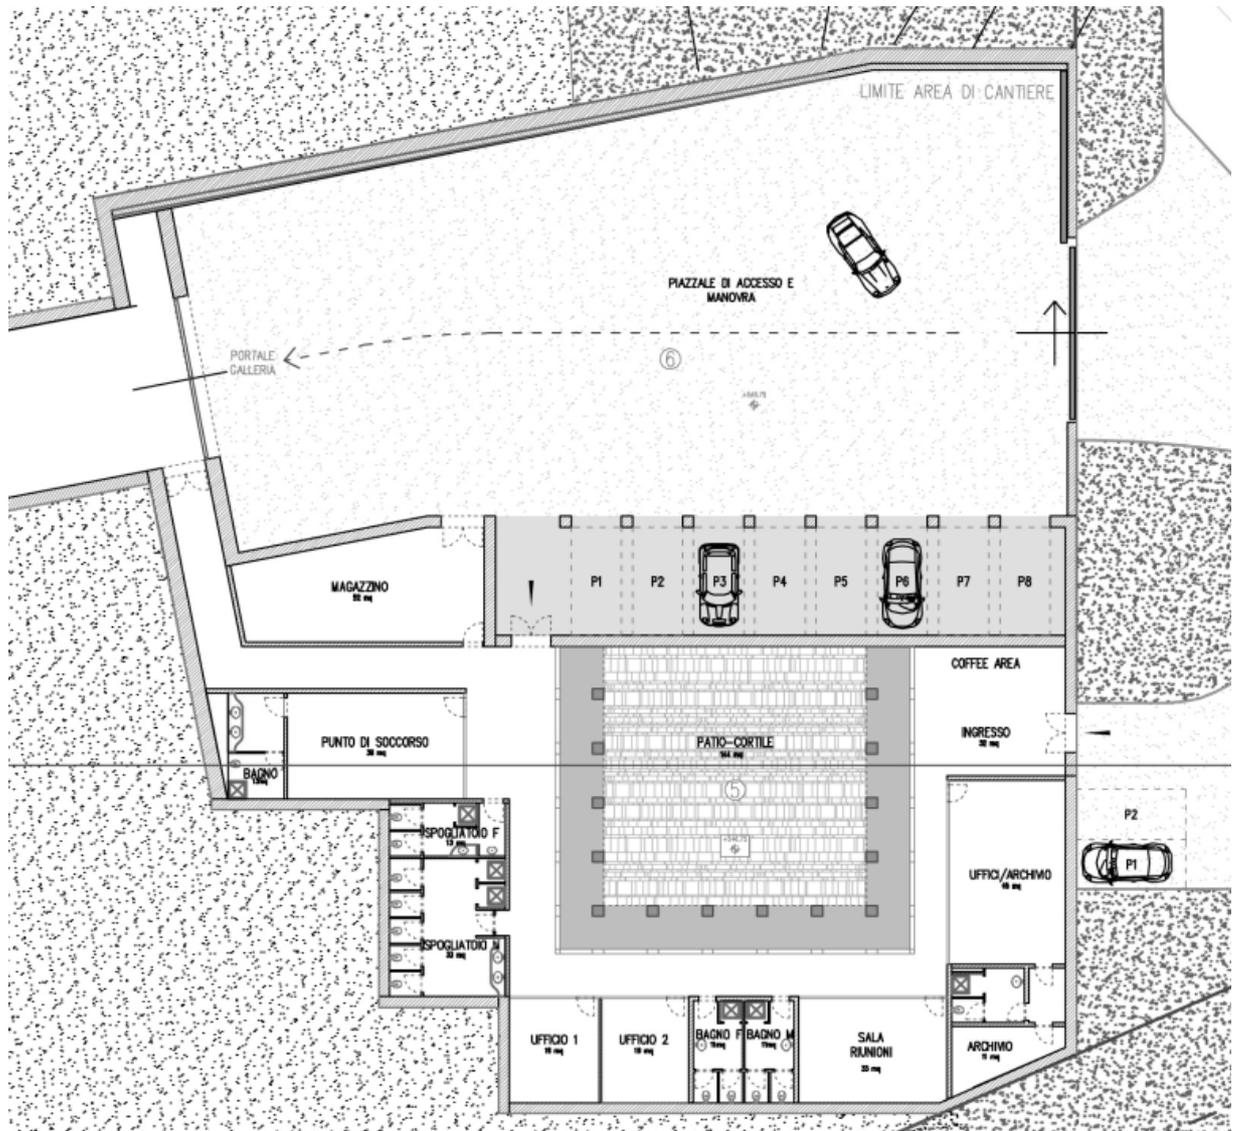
Stralcio Sezione Accesso Centrale ed Edificio
